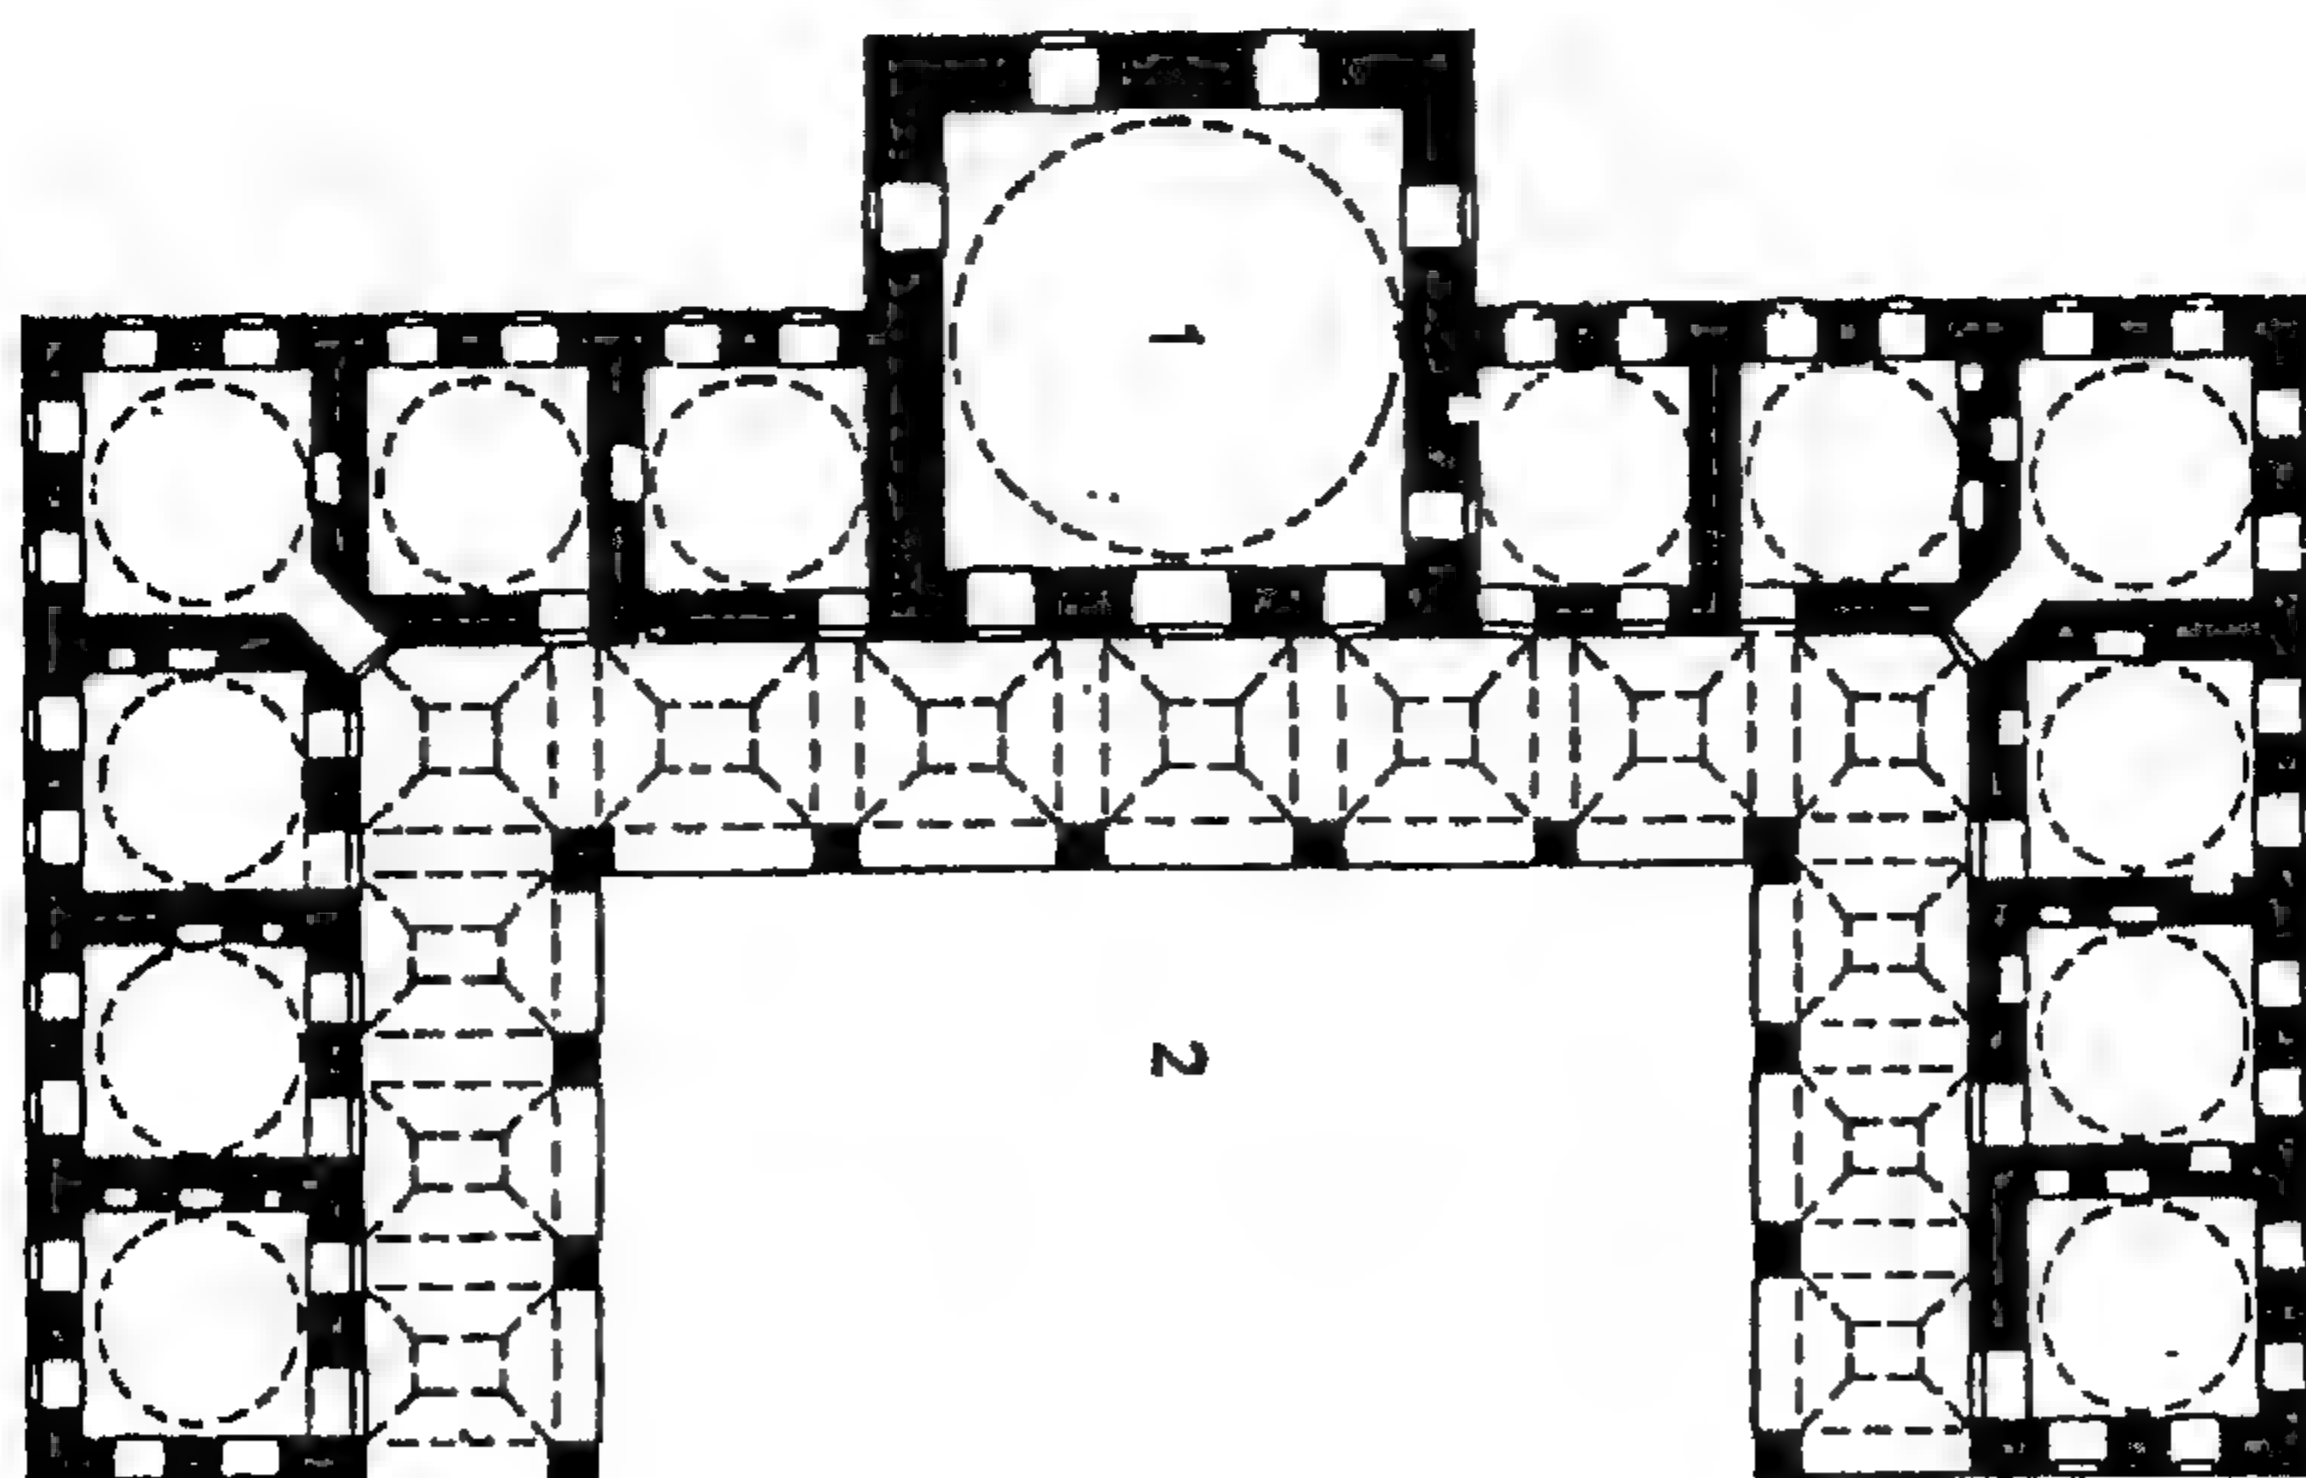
مسقط أفقي للمدرسة ضمن
